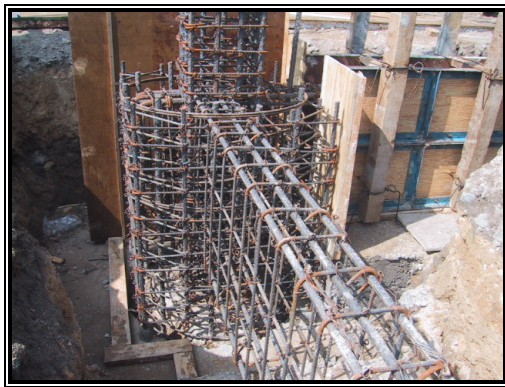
Refuerzo de trabes de liga-pila-columna.
